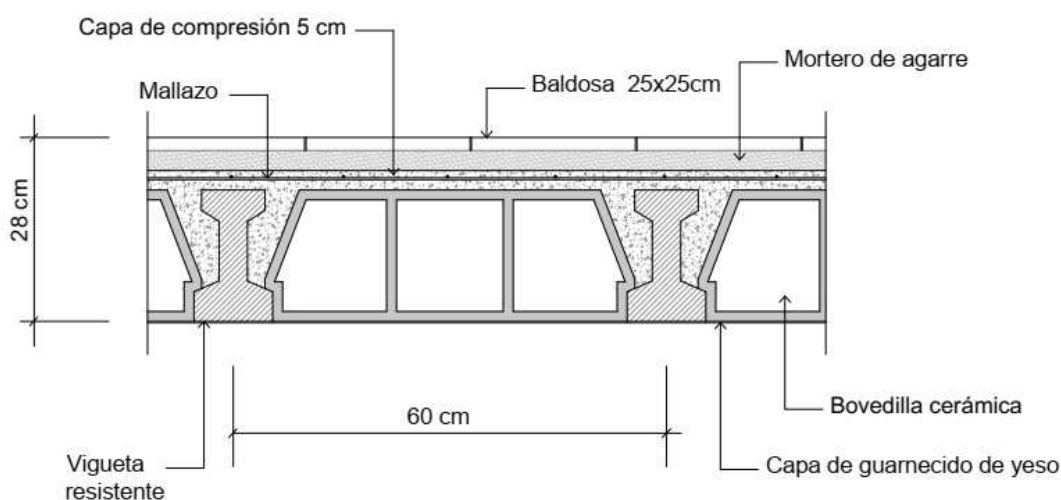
Detalle sección forjado unidireccional. Fuente propia programa AutoCAD
